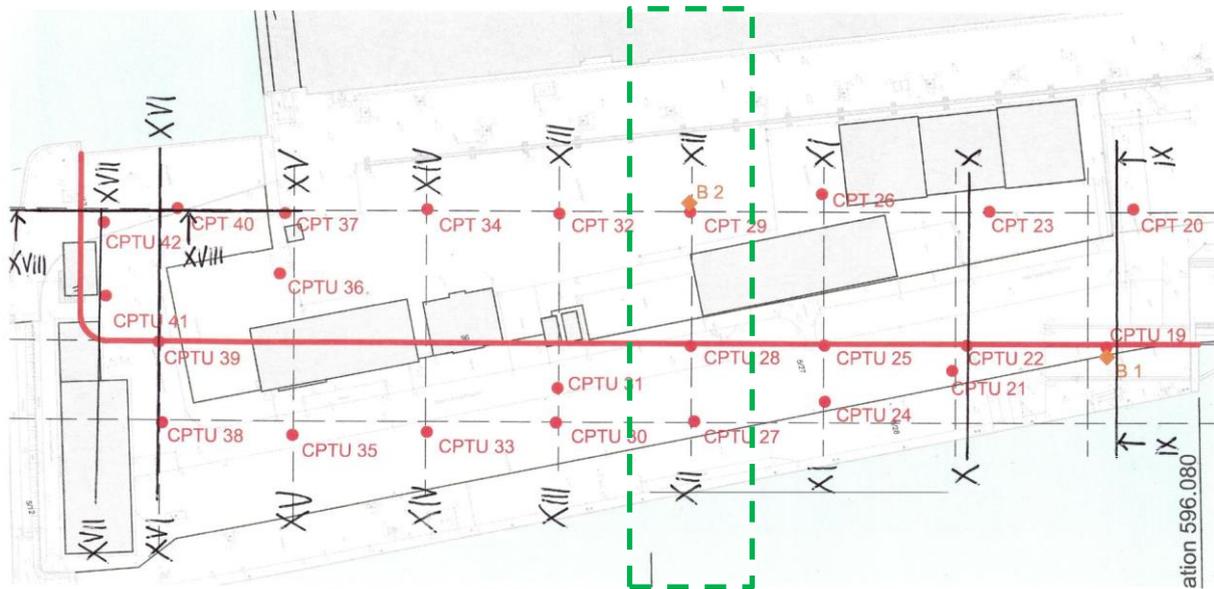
Bemessungsprofil XII - Lage [U1]
